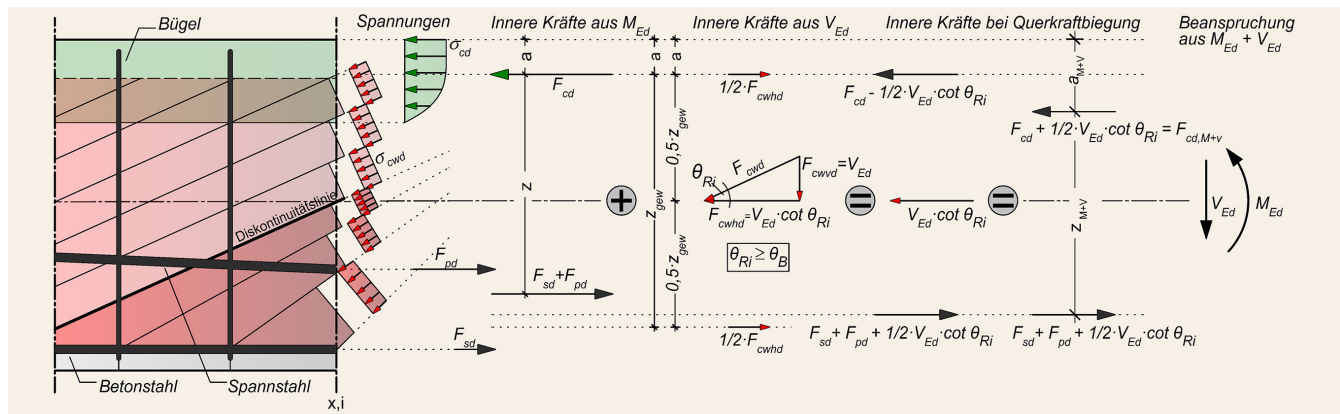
Idealisertes Fachwerkmodell eines Spannbetonbalkens bei Querkraftbiegung im D-Bereich mit positivem einwirkendem Biegemoment
